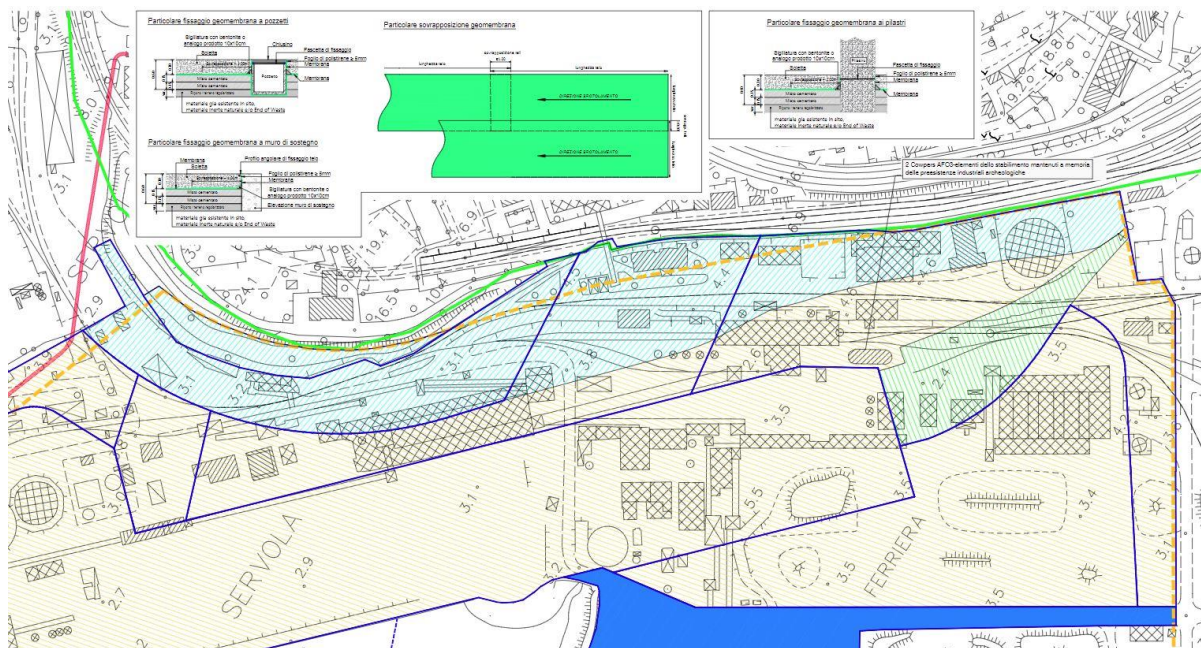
individuazione planimetrica dei pacchetti di MIS
